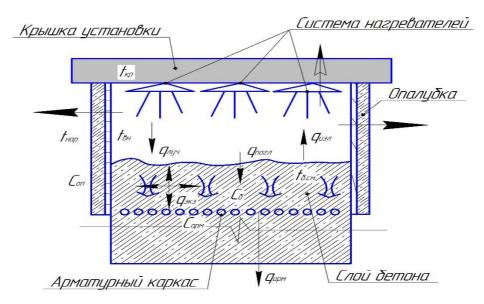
Расчетная схема бетонирования морской железобетонной конструкции
